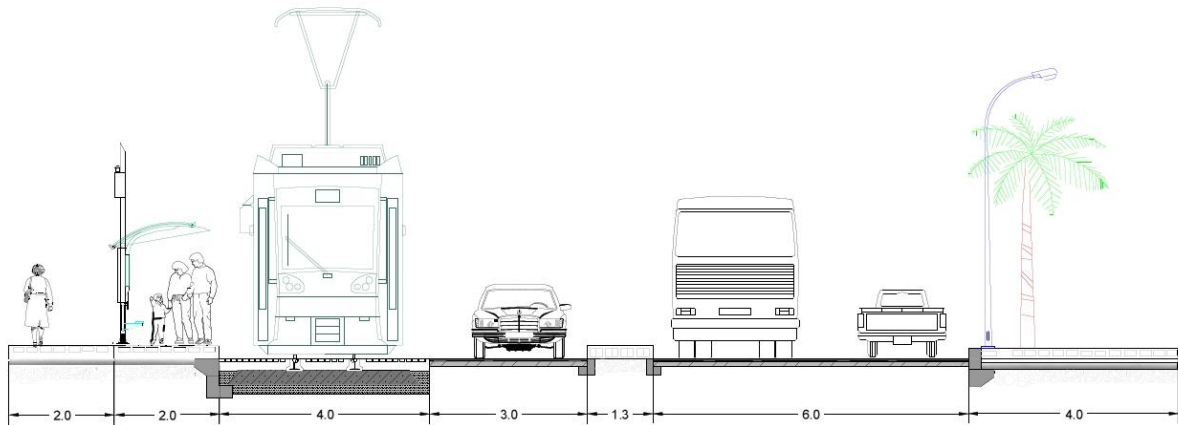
Sección tipo 1. (Fuente: elaboración propia autocad)
